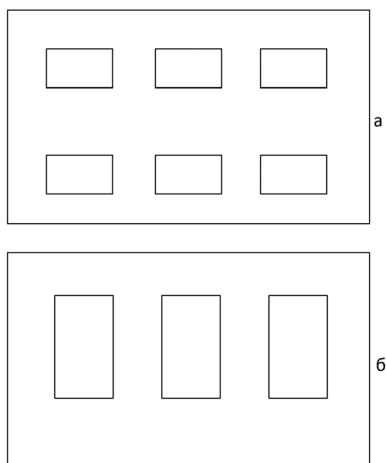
Компоновка главного корпуса ТЭС с 2-х рядным расположением ПГ:
